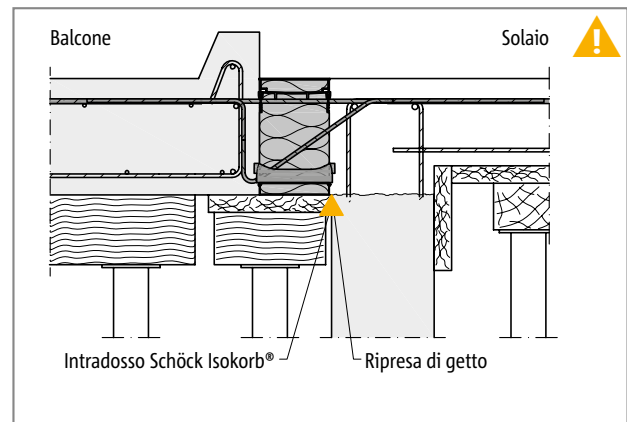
Schöck Isokorb® tipo KXT: balcone finito dotato di solaio con salto di quota su parete preassemblata in calcestruzzo armato.
